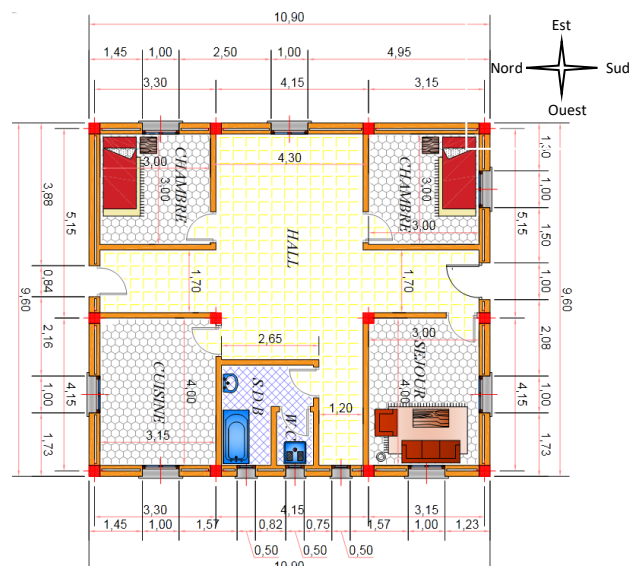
Plan descriptif de la maison (les dimensions sont en mètre)
